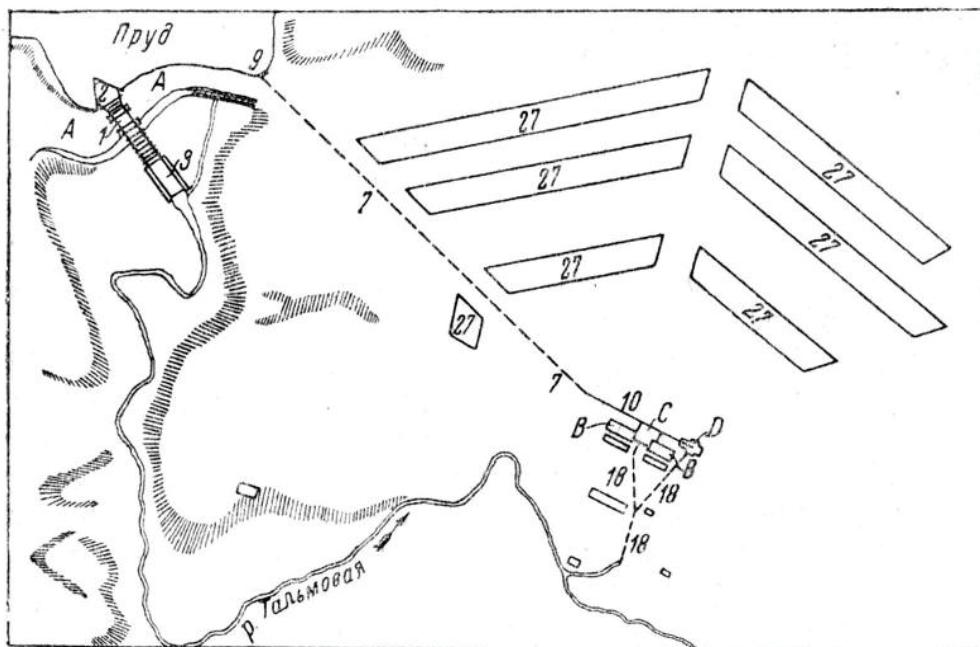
Схематический план гидроузла Гавриловского завода в 1798 г. [10]: А – плотина; 1 – водоспуск; 2 – вешняный двор; 3 – сливной мост; 7 – штолня, подающая воду к гидравлическим колёсам; 9 – запор для пуска воды в деривационную штолнию; 10 - ларь; В – завод; С – воздуходувная установка; D - мусерная толчея; 18 – каналы для отработавшей воды; 27 – заводской посёлок
